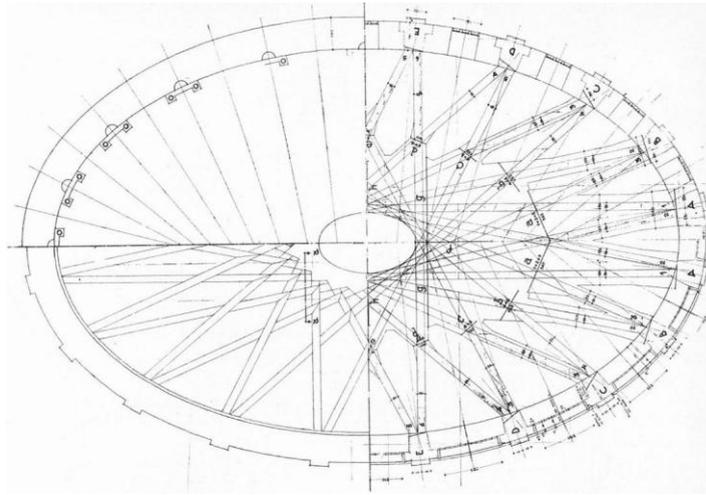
Planta esquemática del entramado de nervaduras (arcos).
